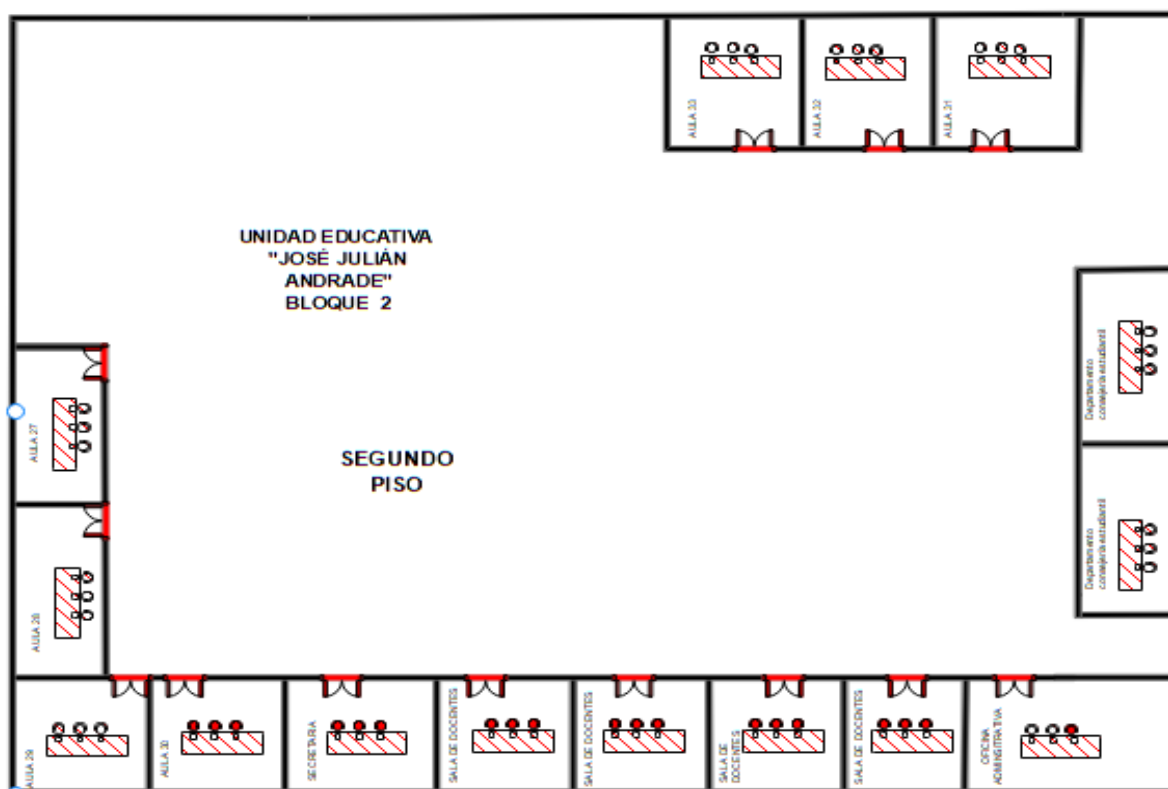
Plano de la estructura del bloque 2, segundo piso de la institución
